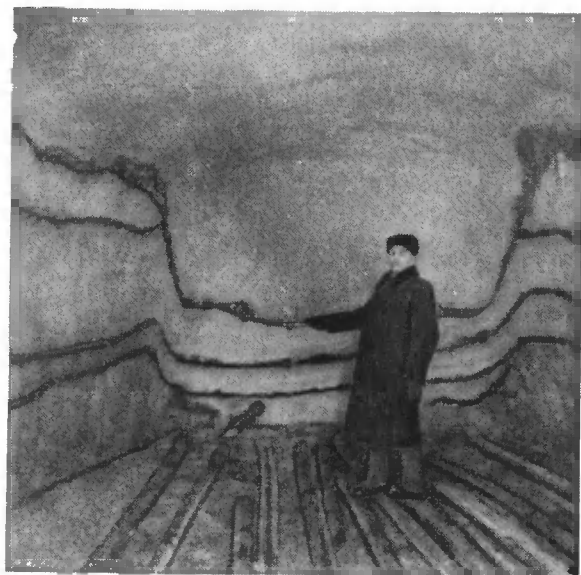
Следы опилочной теплоизоляции в наружной стене ледяного склада
